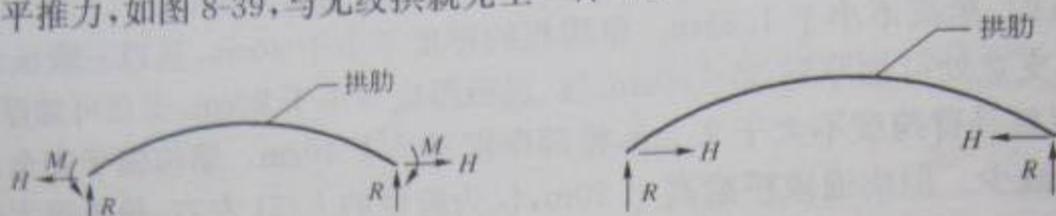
无绞拱与下承式预应力混凝土系杆拱肋的受力图示
